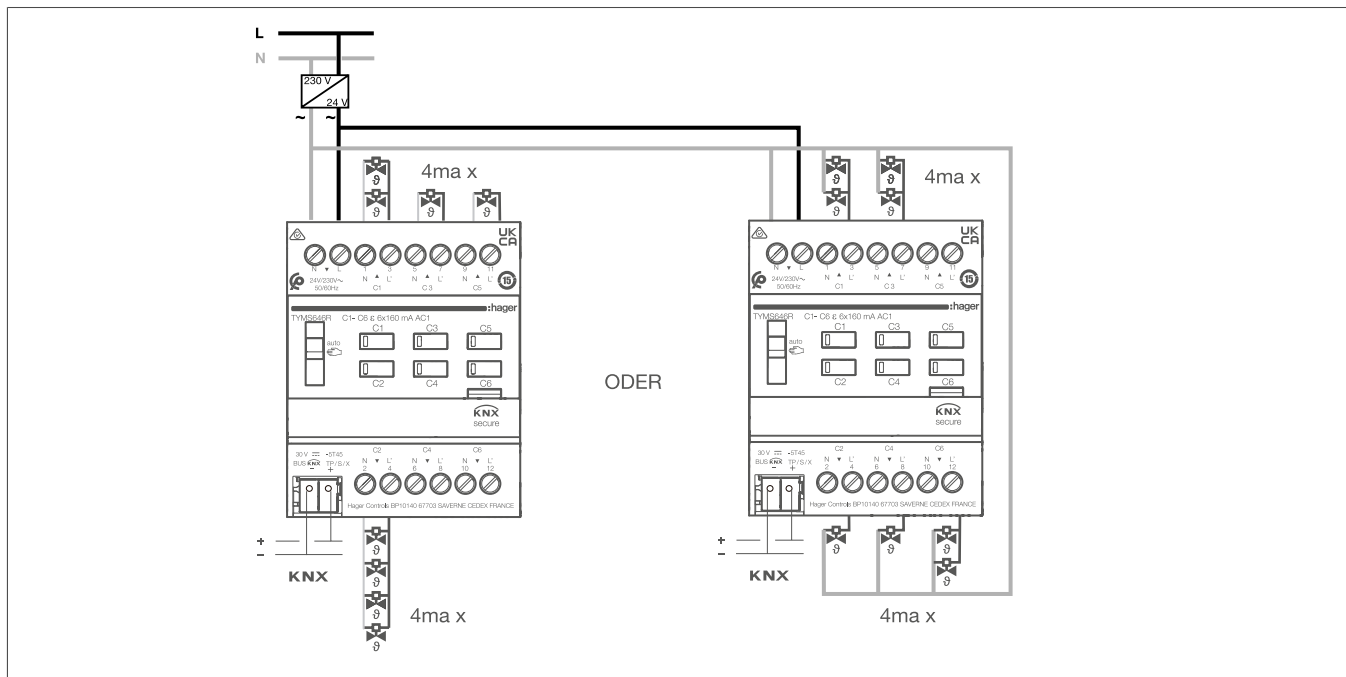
Schema di collegamento per elettrovalvole — con alimentazione a 24 V~
